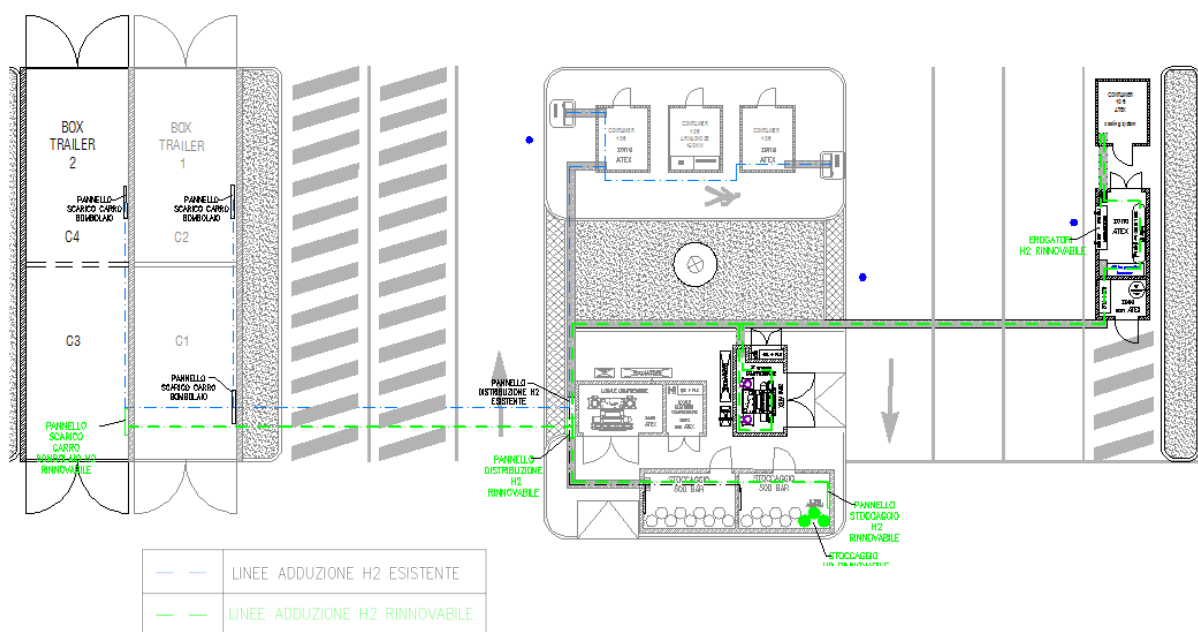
Schema planimetrico dell'ampliamento dell'impianto (350/700 bar) con suddivisione idrogeno Green e blu
